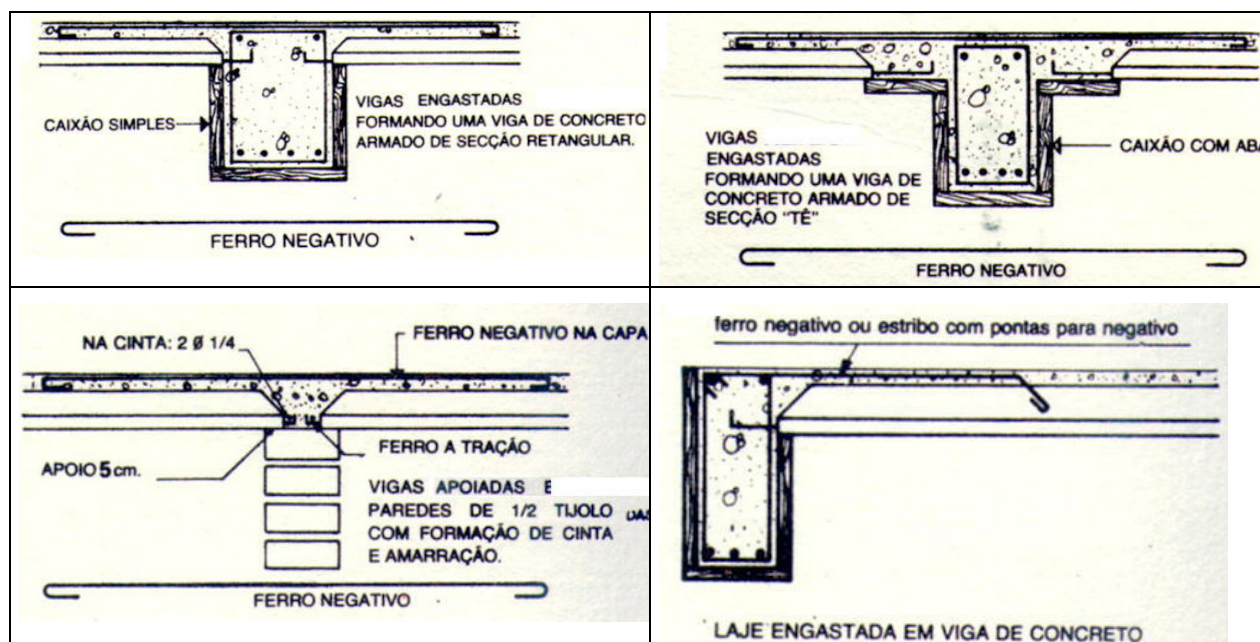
Detalhes da armadura negativa (LAJES ALMEIDA).
